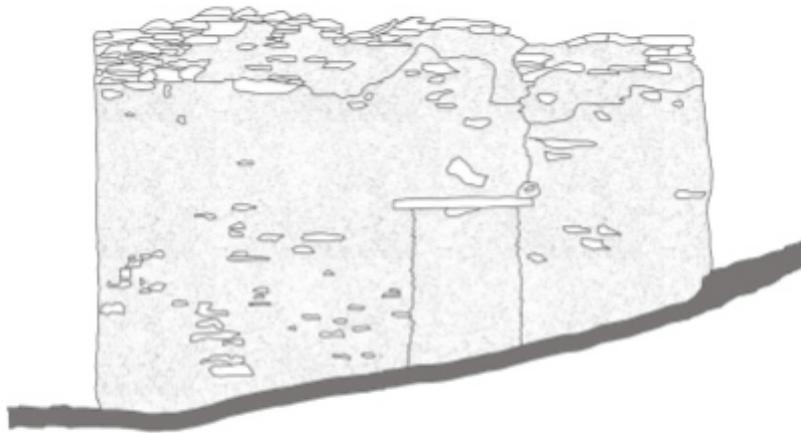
Andriani Mario. prospetto sud-ovest sc. 1:100
